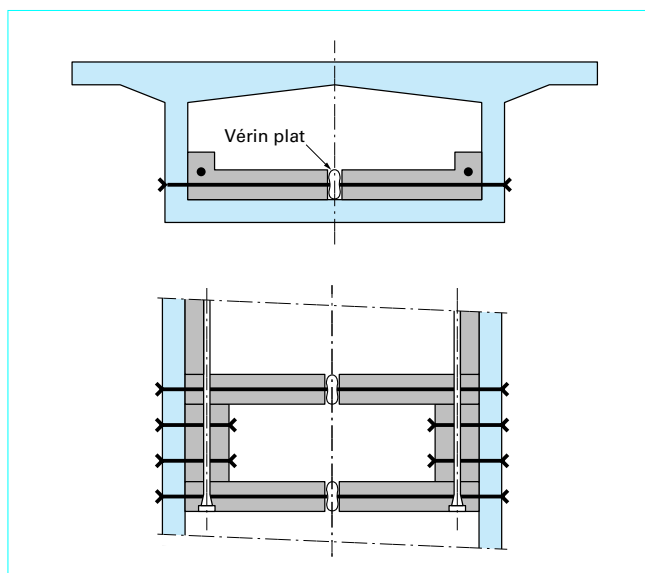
Compensation des déformations par vérins plats d'un bouton rapporté
